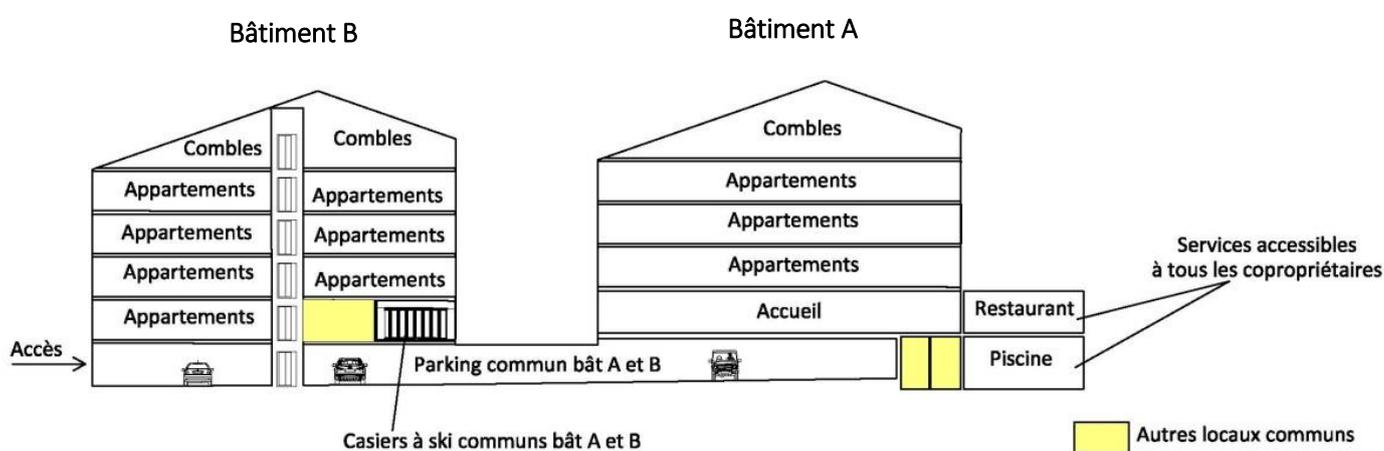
Coupe des bâtiments A et B, "Le Village de Praroustan"
